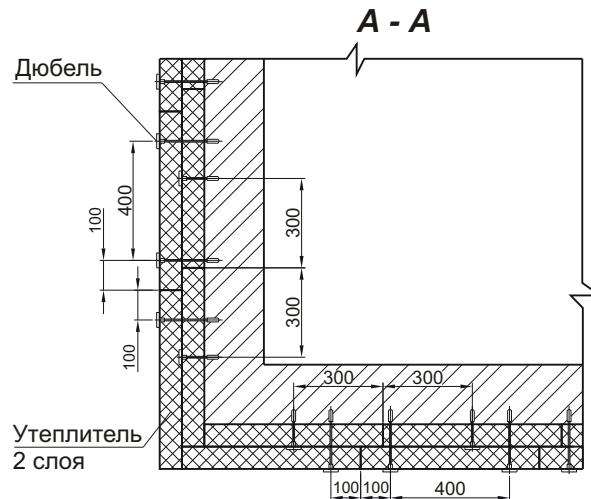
Принципиальная схема крепления утеплителя на углу здания
